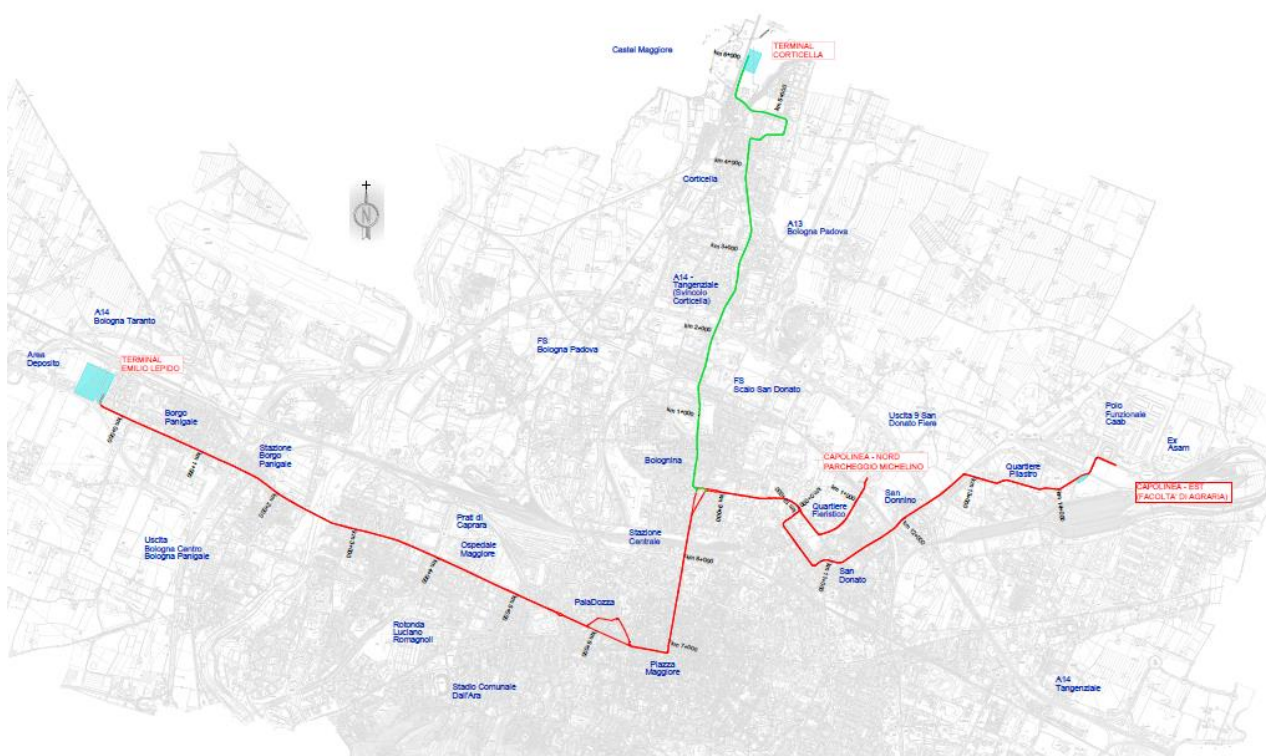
Planimetria generale Linea Rossa + Tratta nord Linea Verde
